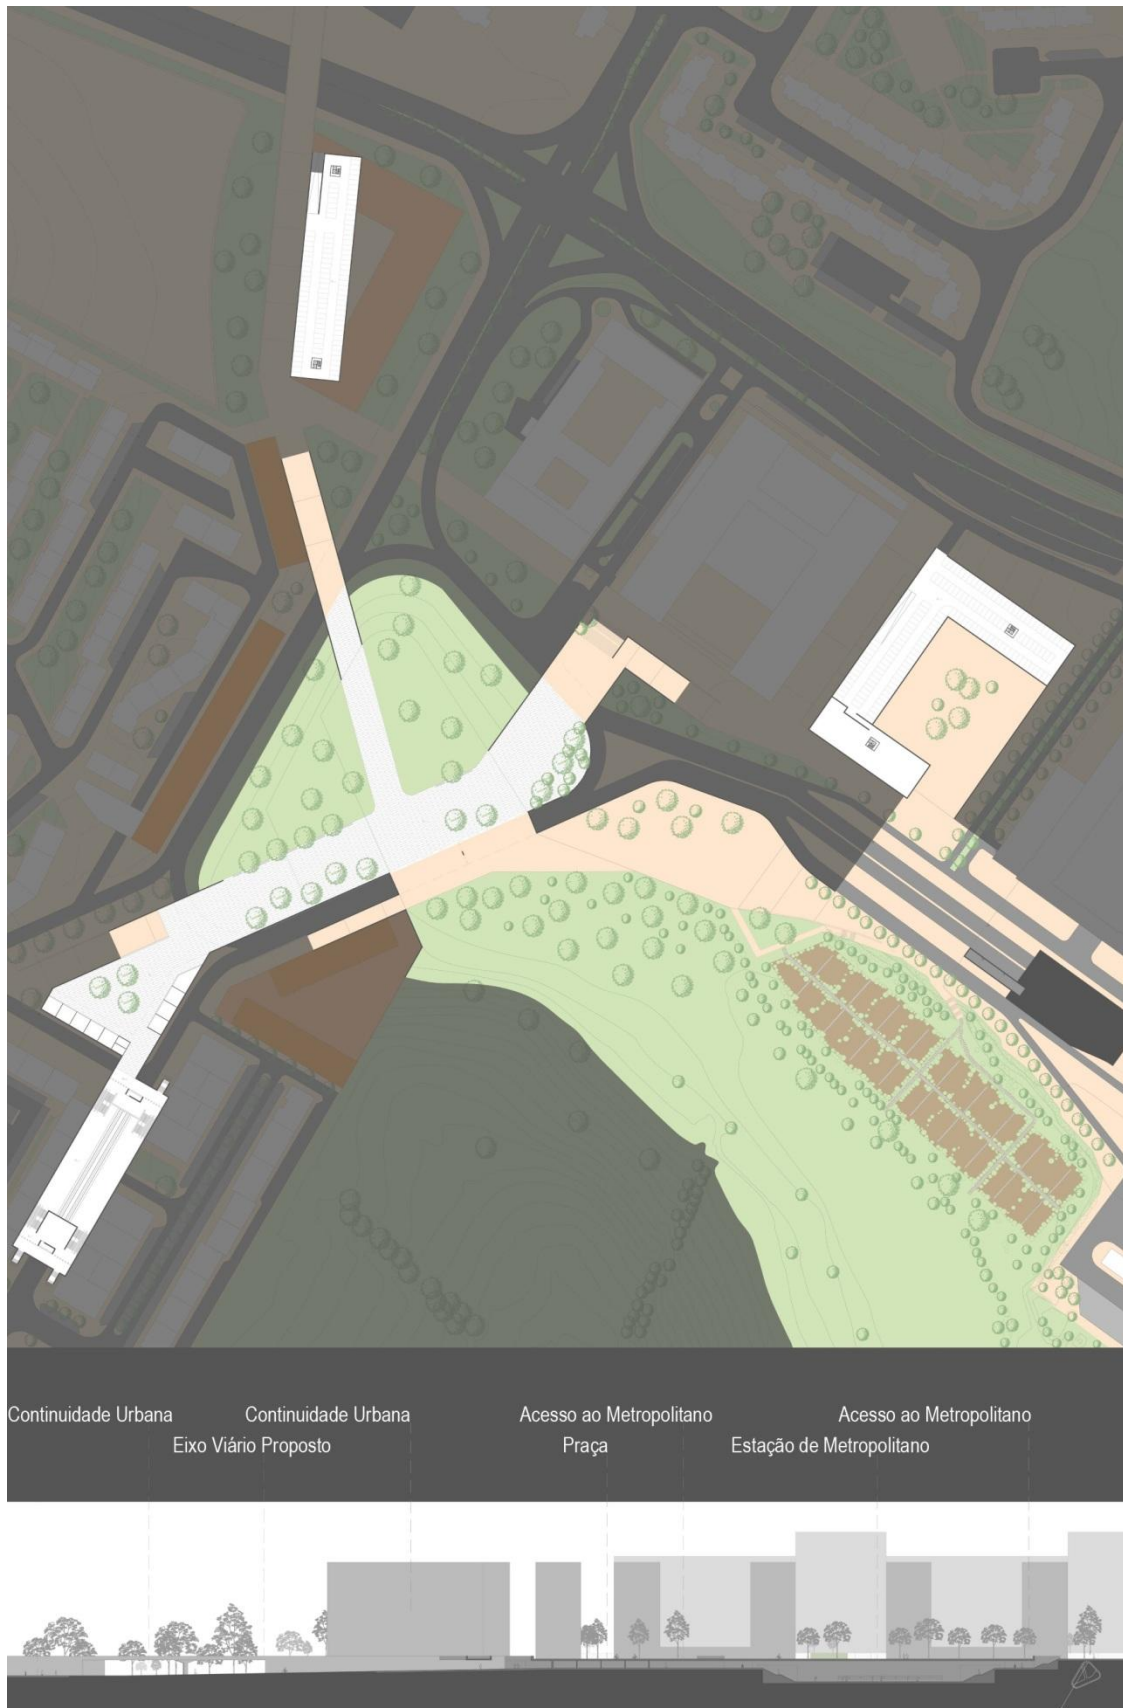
| Planta da Proposta . Cota 83 | Corte AB
